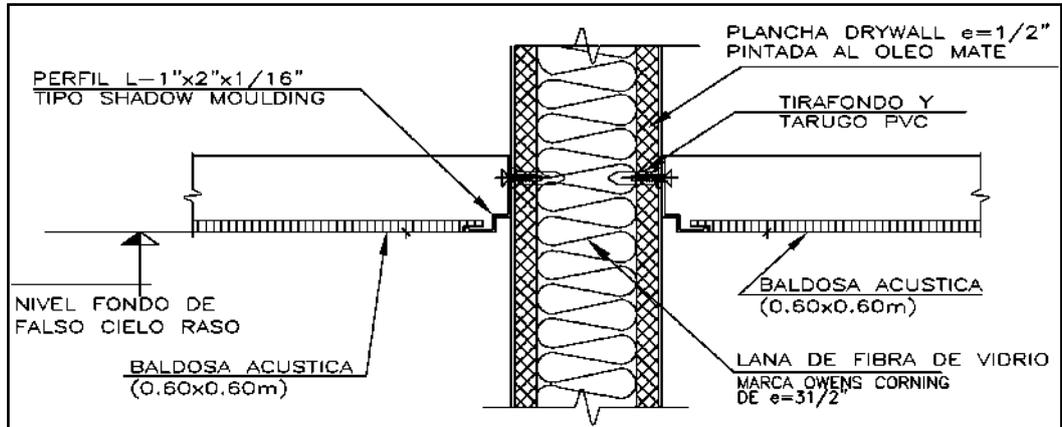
Aislamiento acústico. FUENTE: Elaboración Propia
